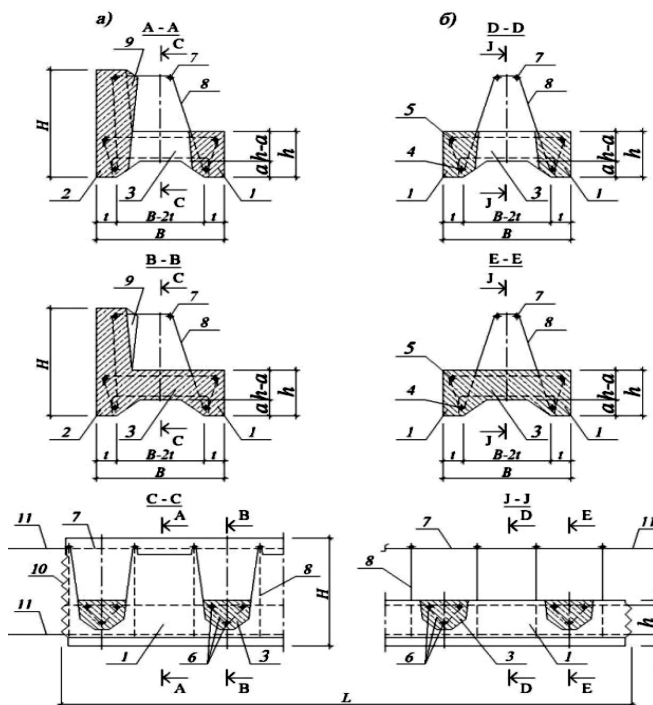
Сборный поясной блок длиной L наружных (а) и внутренних (б) стен здания: 1 - внутренняя (опорная) стенка; 2 - наружная (ограждающая) стенка; 3 - перемычки соединяющие стенки между собой, приподнятые над опорой; 4 - рабочая арматура в блоке; 5 - конструктивная арматура стенок; 6 - арматура перемычек; 7 - рабочая арматура монолитного бетона; 8 - выпуски поперечной арматуры; 9 - рабочие шпонки; 10 - монтажные шпонки; 11 - монтажные выпуски арматуры [разработка автора].
